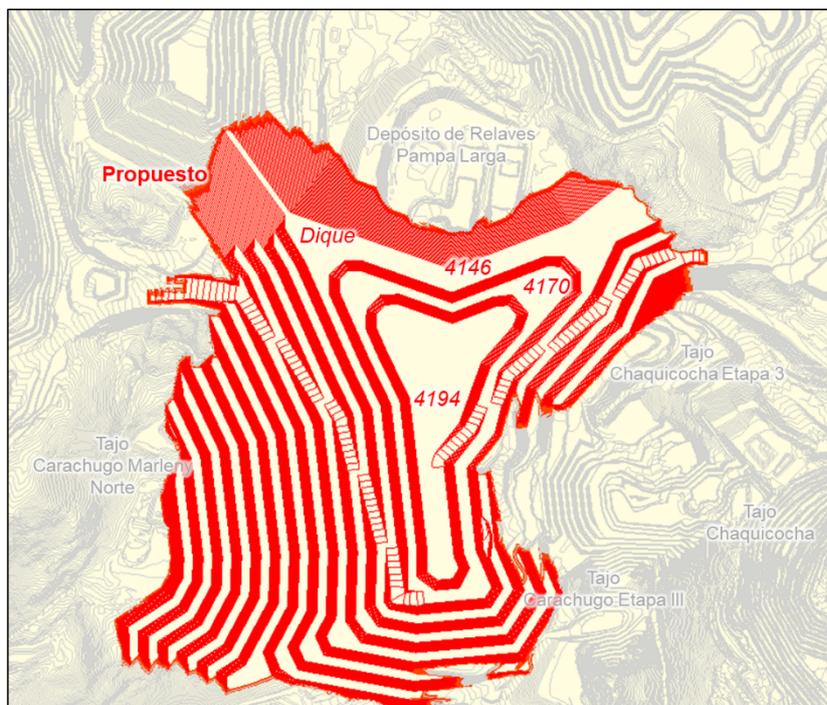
Plan de descarga del Relleno Carachugo Etapa 3 – Años 2037 al 2040 – Vista en planta
